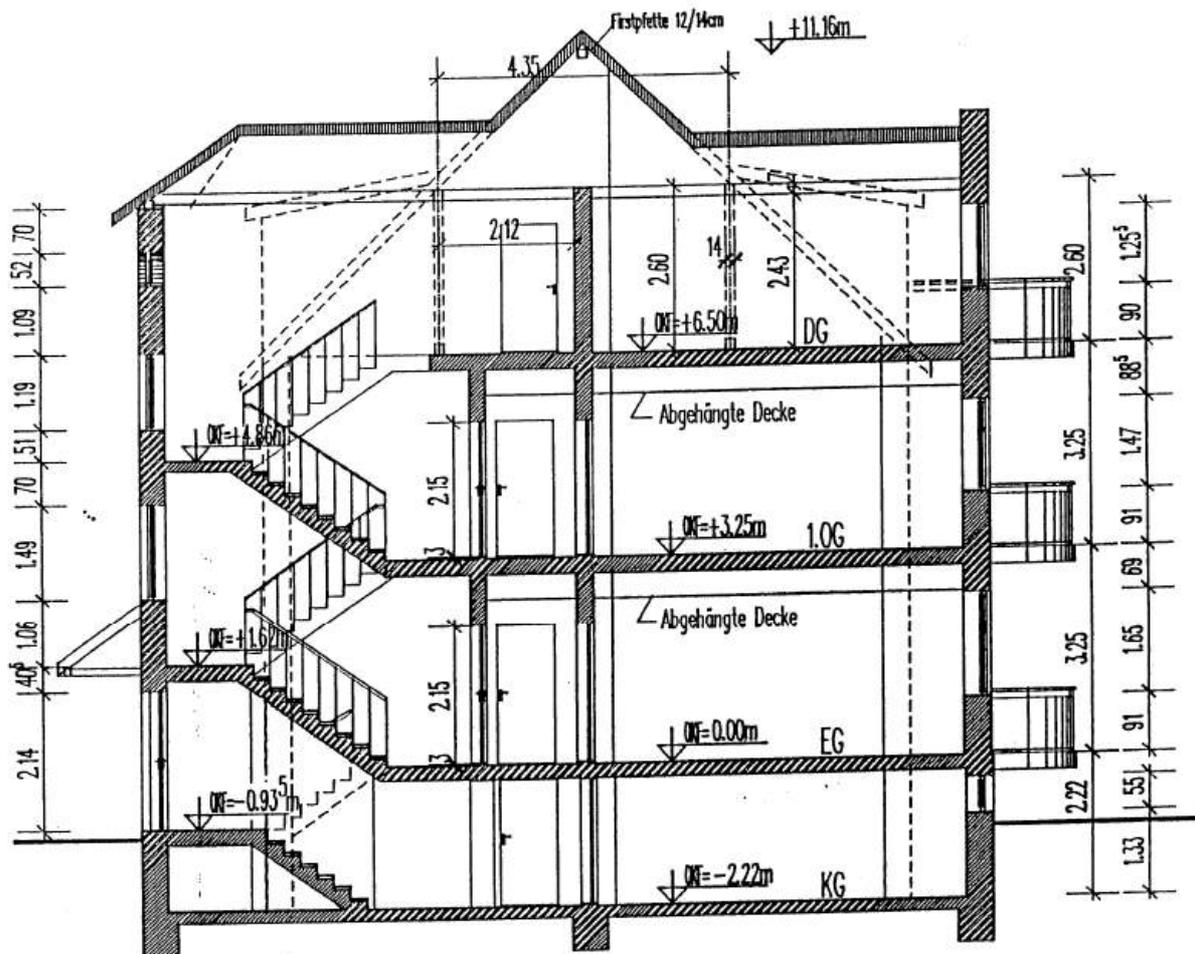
Querschnitt Gebäude, Planausschnitt o.M.
